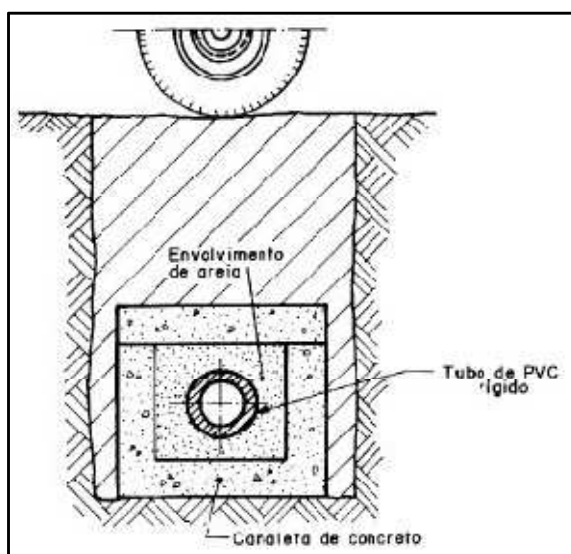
Proteção da tubulação com canaletas e tampa de concreto
